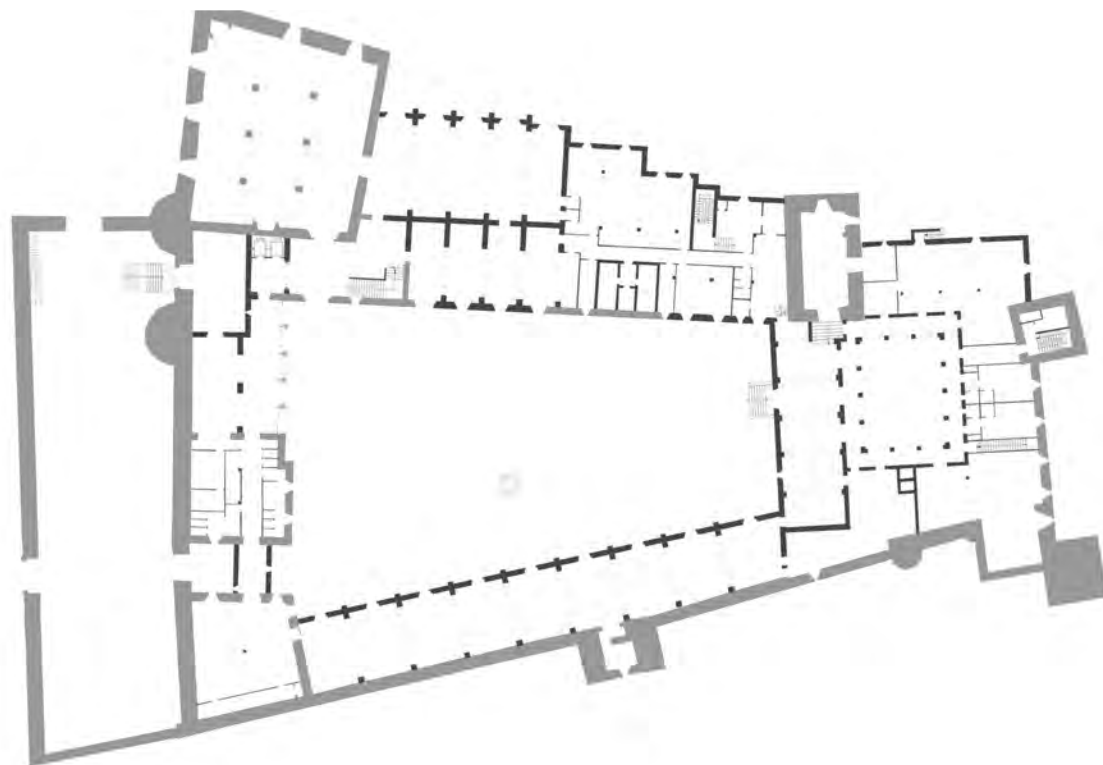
Planta baja del castillo-parador de Sigüenza, en el que se indican en gris los muros históricos y en negro los reconstruidos o nuevos (Elaboración de la autora a partir del plano de José Luis Picardo (27-2-1973) [AITE]).
